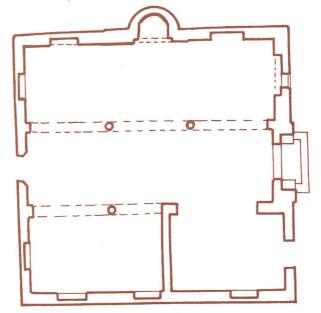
المسقط الأفقى لمسجد مكرم بدمنهور مقياس رسم ١: ٥٠
